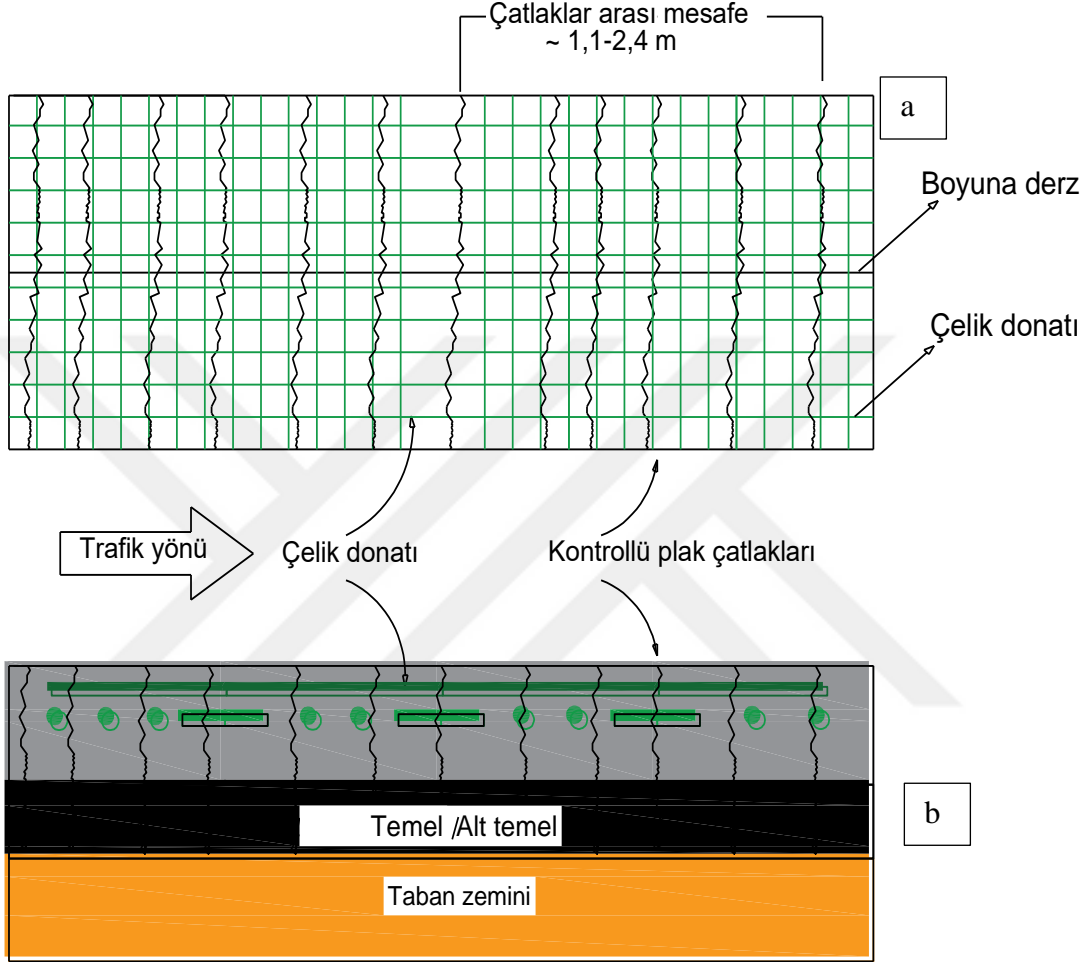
Derzli donatılı beton kaplamaya ait plan (a) ve kesit (b) görüntüsü (URL-3).
